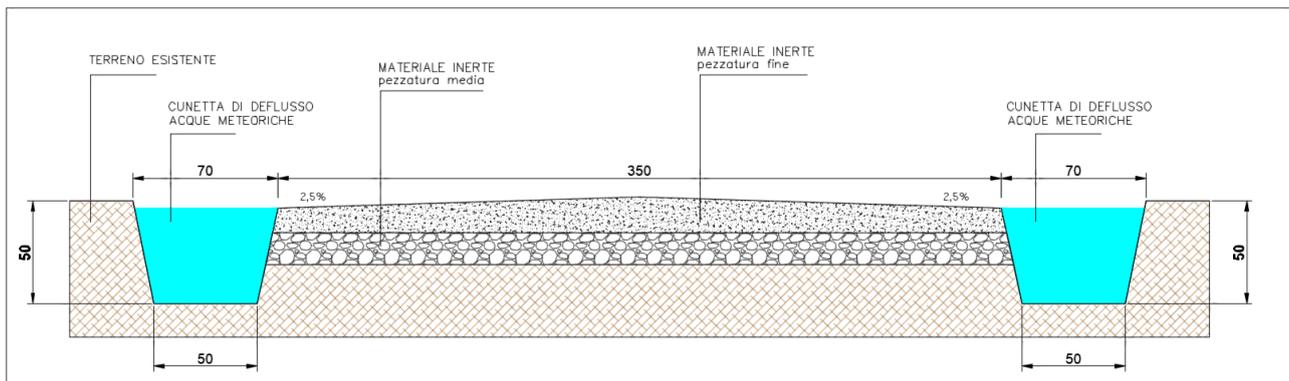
Sezione stradale e drenaggio acque meteoriche
